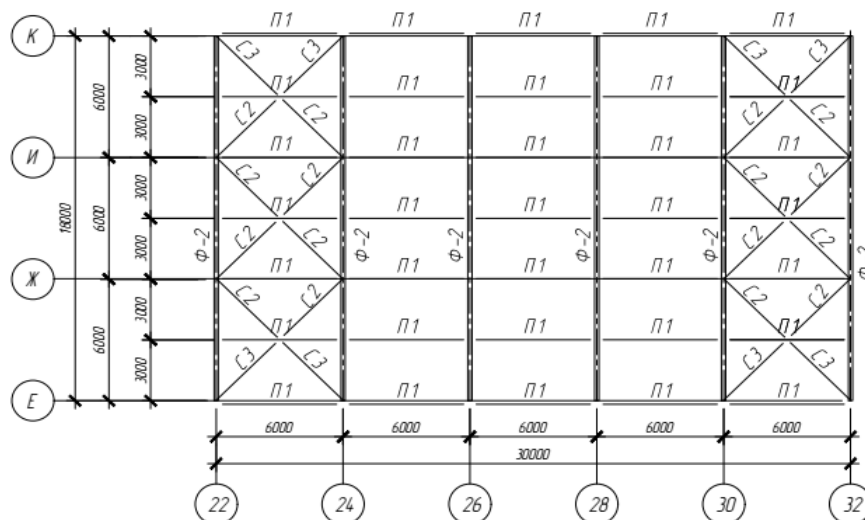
Схема расположения стропильных ферм, прогонов и связей по верхним поясам ферм в осях 22-32/Е-К
